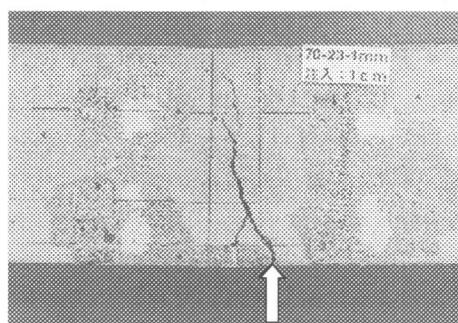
樹脂注入後の曲げ載荷による新たなひび割れの発生 (W/C=0.7、注入 1cm)
